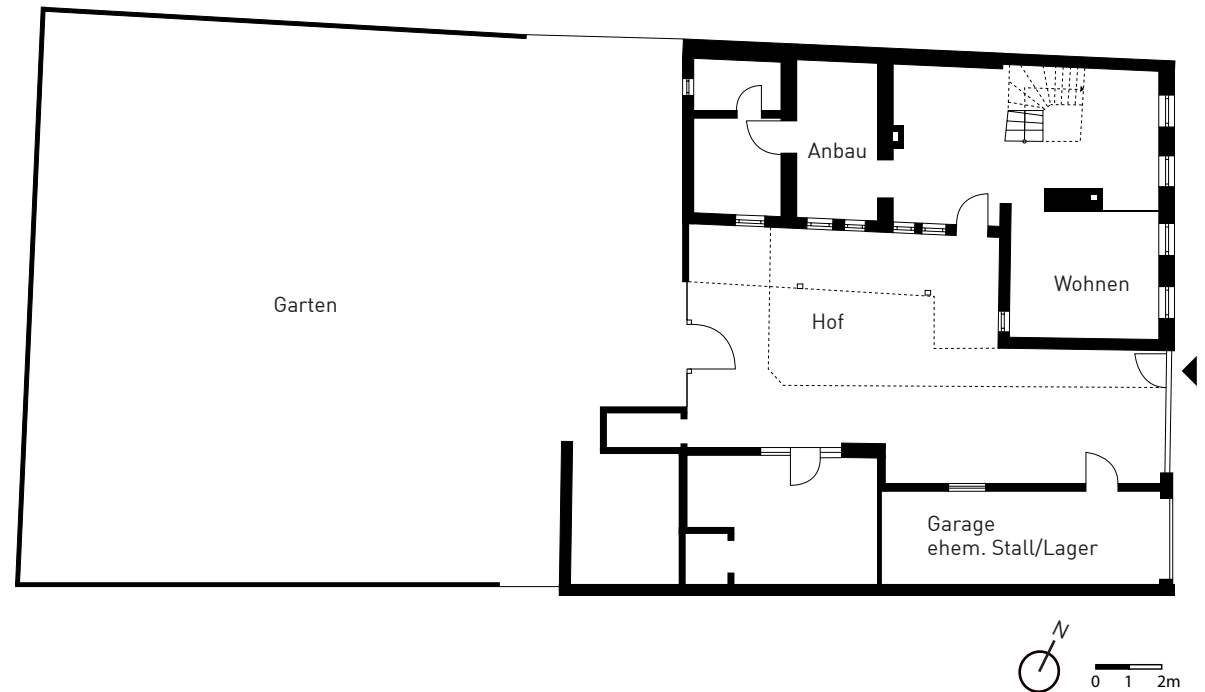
Erdgeschoss Grundriss, 2021.
